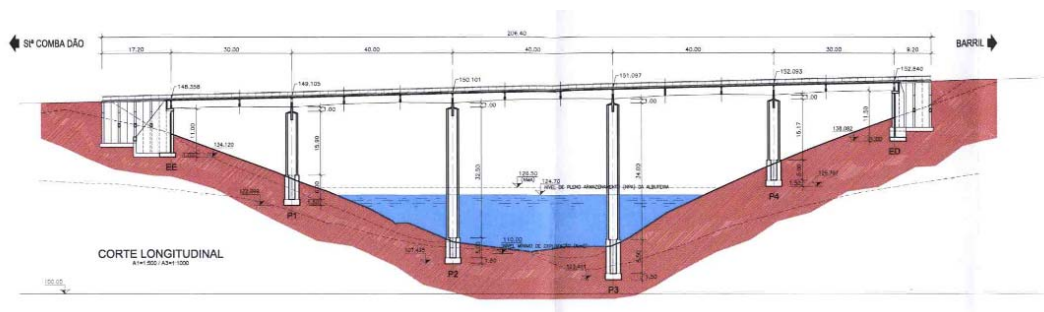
Inspecções Agueira - Corte longitudinal da Ponte sobre o Rio Criz
